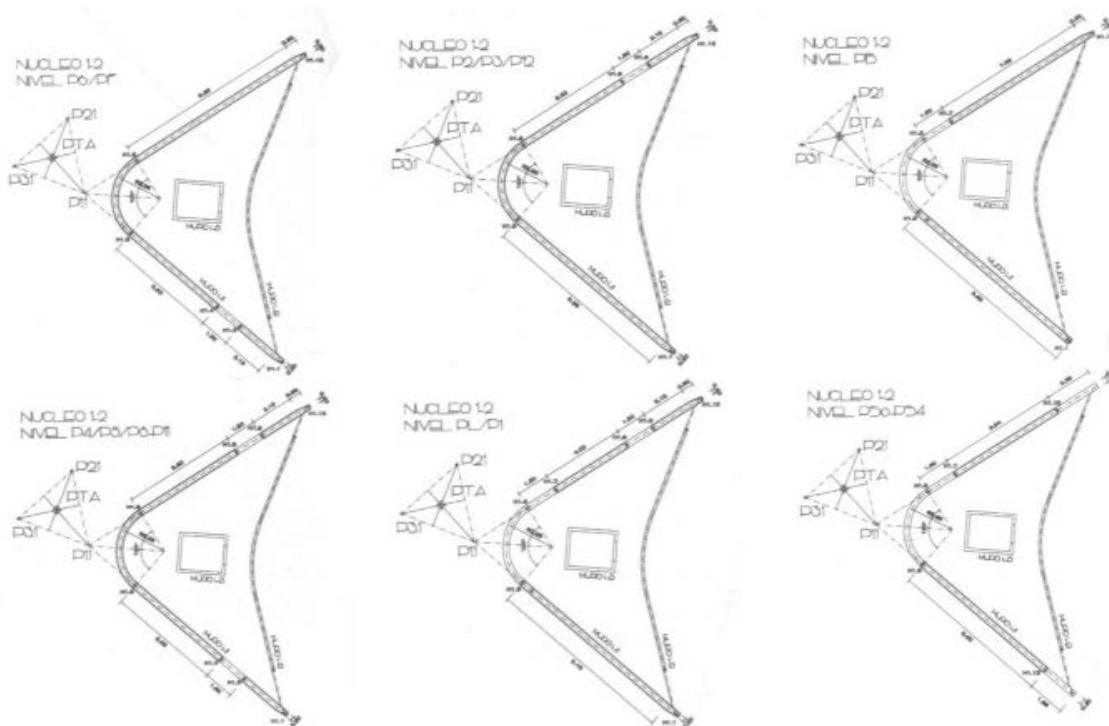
Desarrollo por plantas de los núcleos de hormigón. Documentos de Arquitectura nº 60. Revista del Colegio de Arquitectos de Almería.
